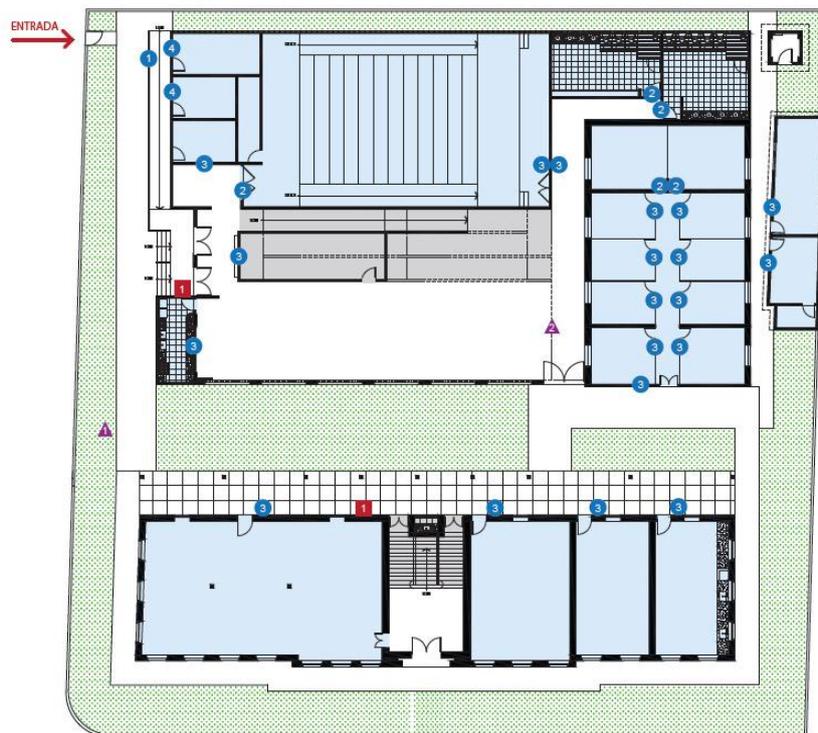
Marcação dos tipos de sinalização, no térreo da Casa Rosada. Fonte: adaptado da planta IFPB
